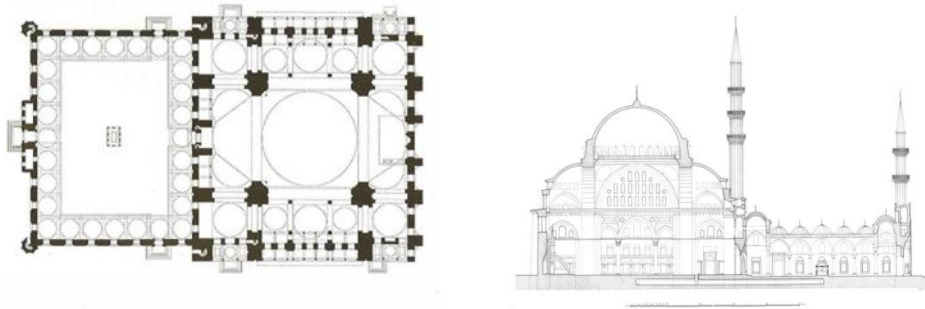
Şehzade Plan ve Kesiti (Gül, 2019)
